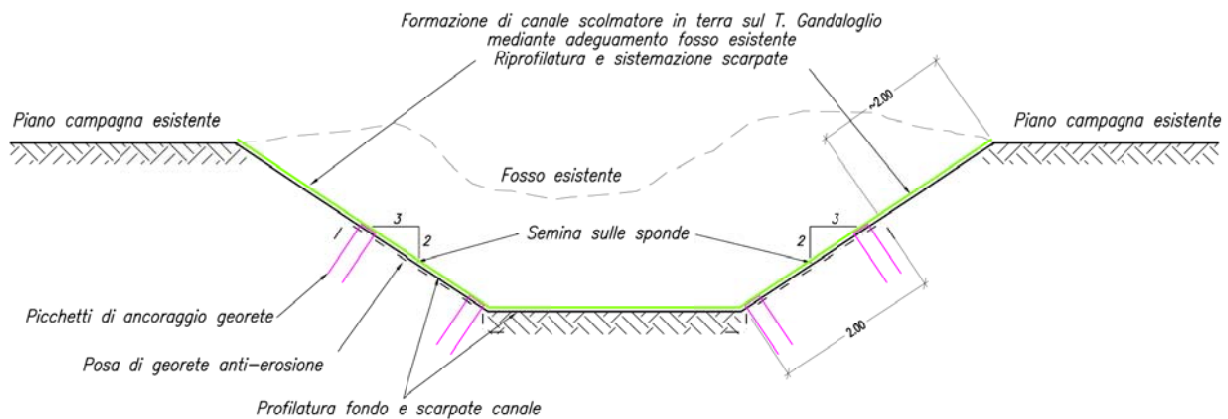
sezione tipo del canale scolmatore a valle dell'attraversamento ferroviario - Stralcio tavola C-06-01 prog. Lotto 1
